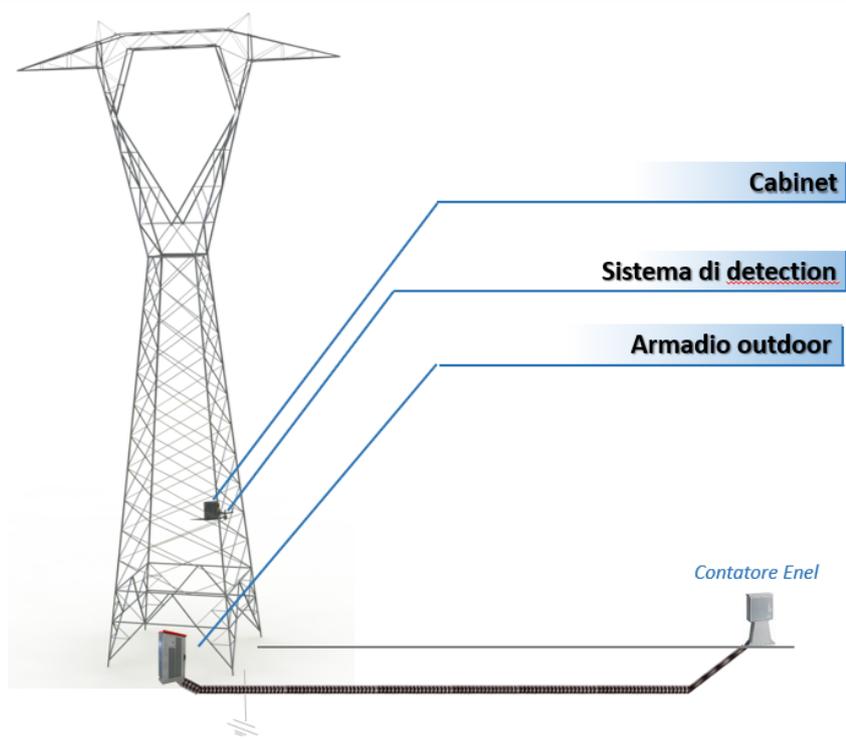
soluzione Smart Tower (alimentazione in bassa tensione)
